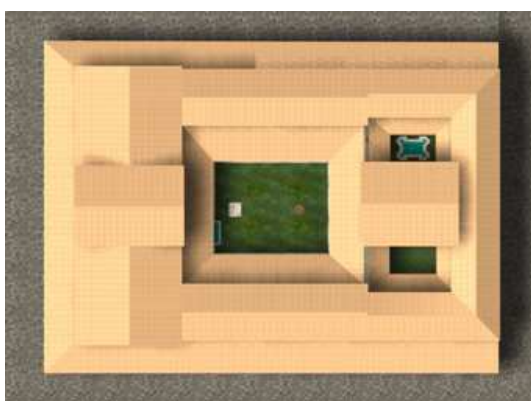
y 126. Planta y fachada ¾ del exterior de la Casa de Hylas.
